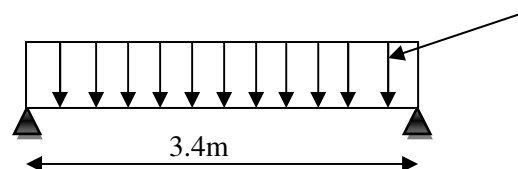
Schéma statique de la poutre palière de rez de chaussée
